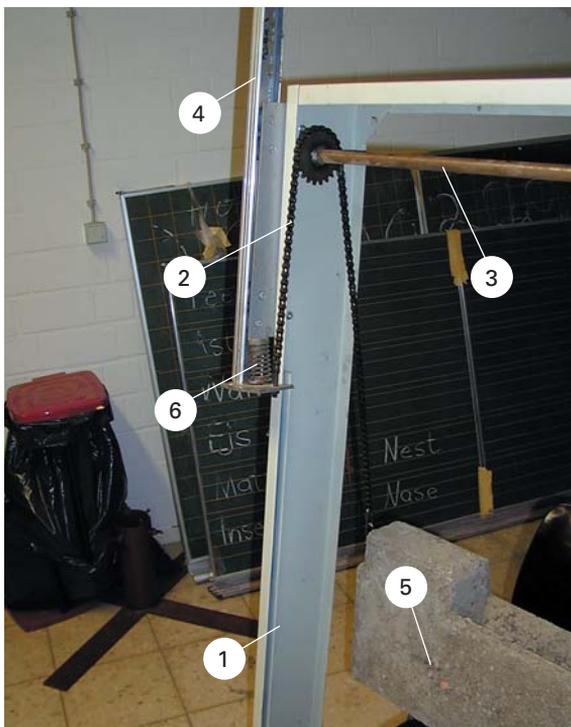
Schiebe-Tafel (Innenansicht) mit innenliegender Rollenführung
